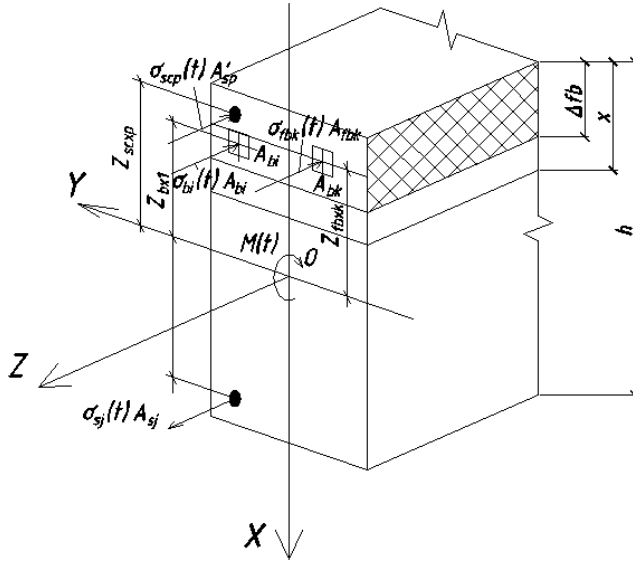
Расчетная схема нормального сечения изгибаемого железобетонного элемента с зонным армированием в сжатой зоне в относительных единицах
